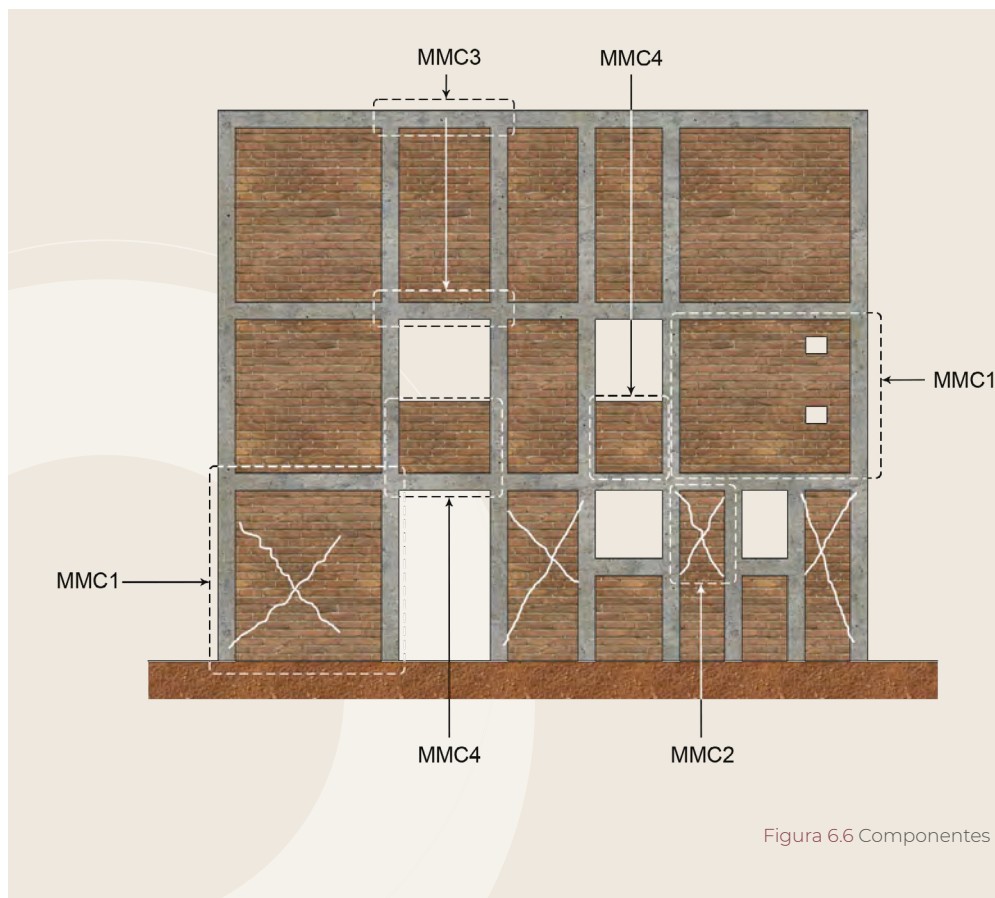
Componentes de muros de mampostería confinada. Fuente: elaboración propia.
